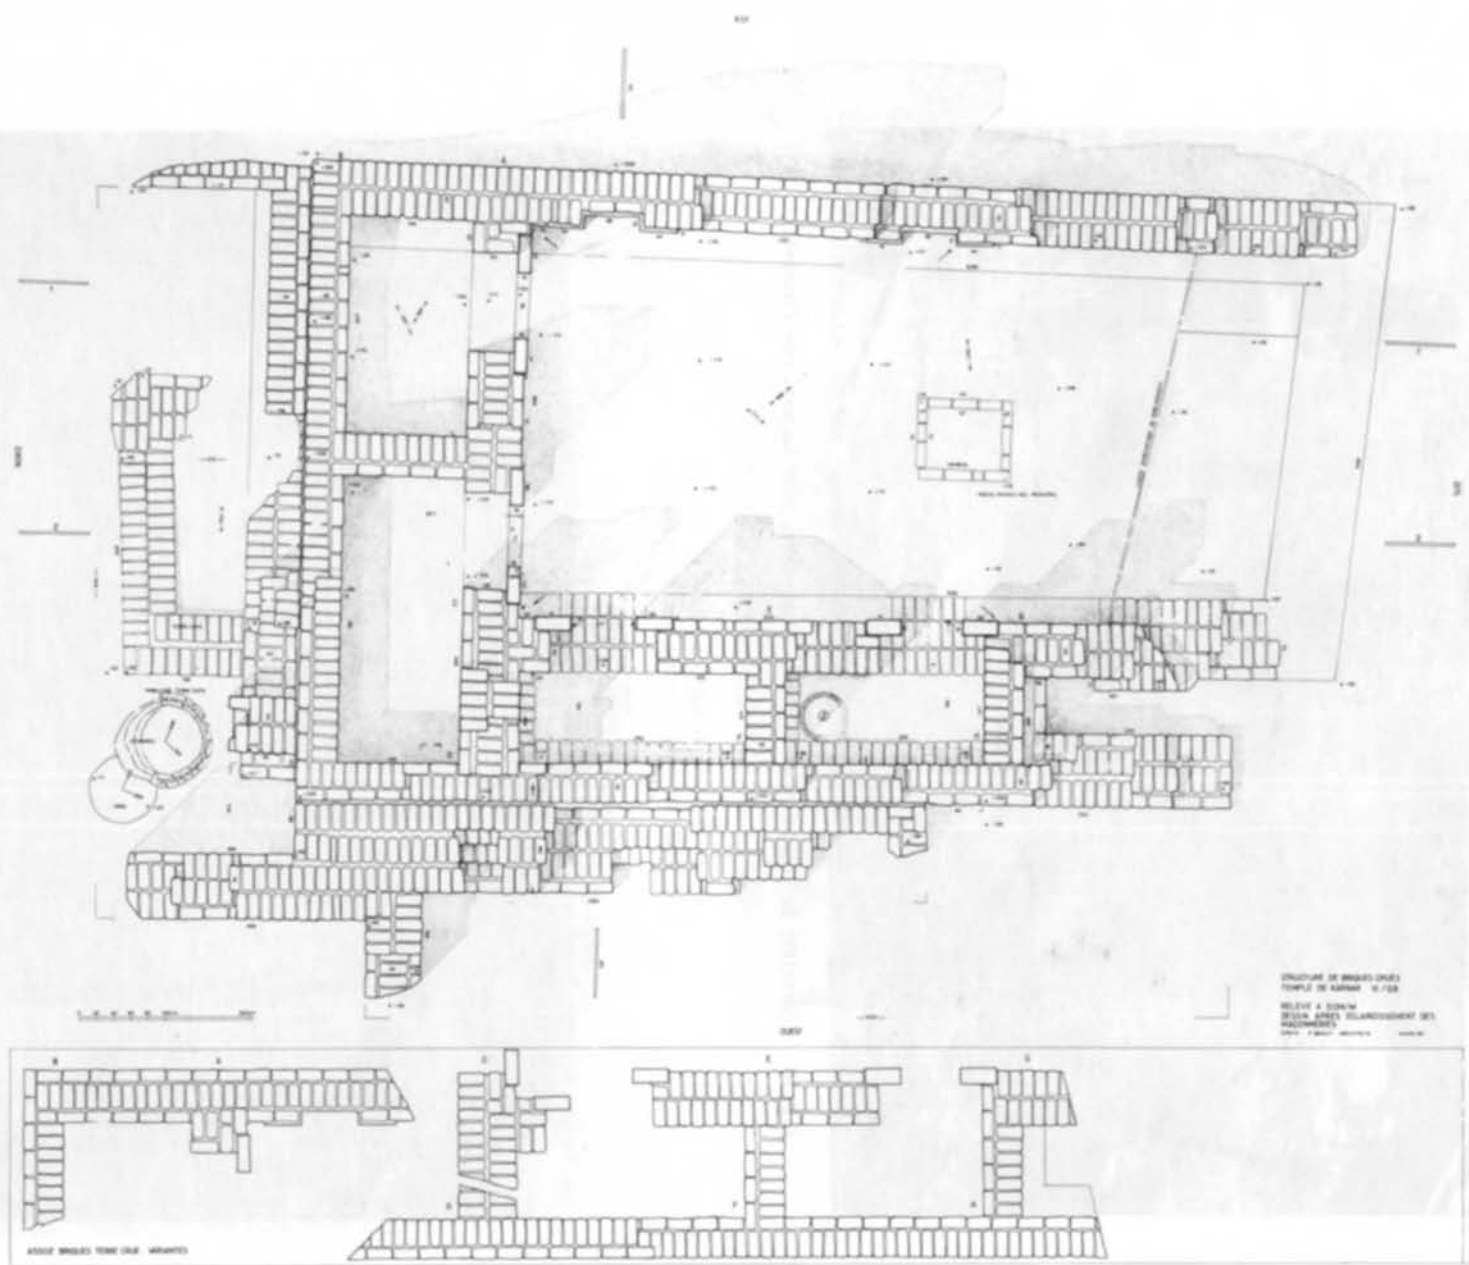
Plan de la structure de briques rubéfiées (P. BEOUT).
